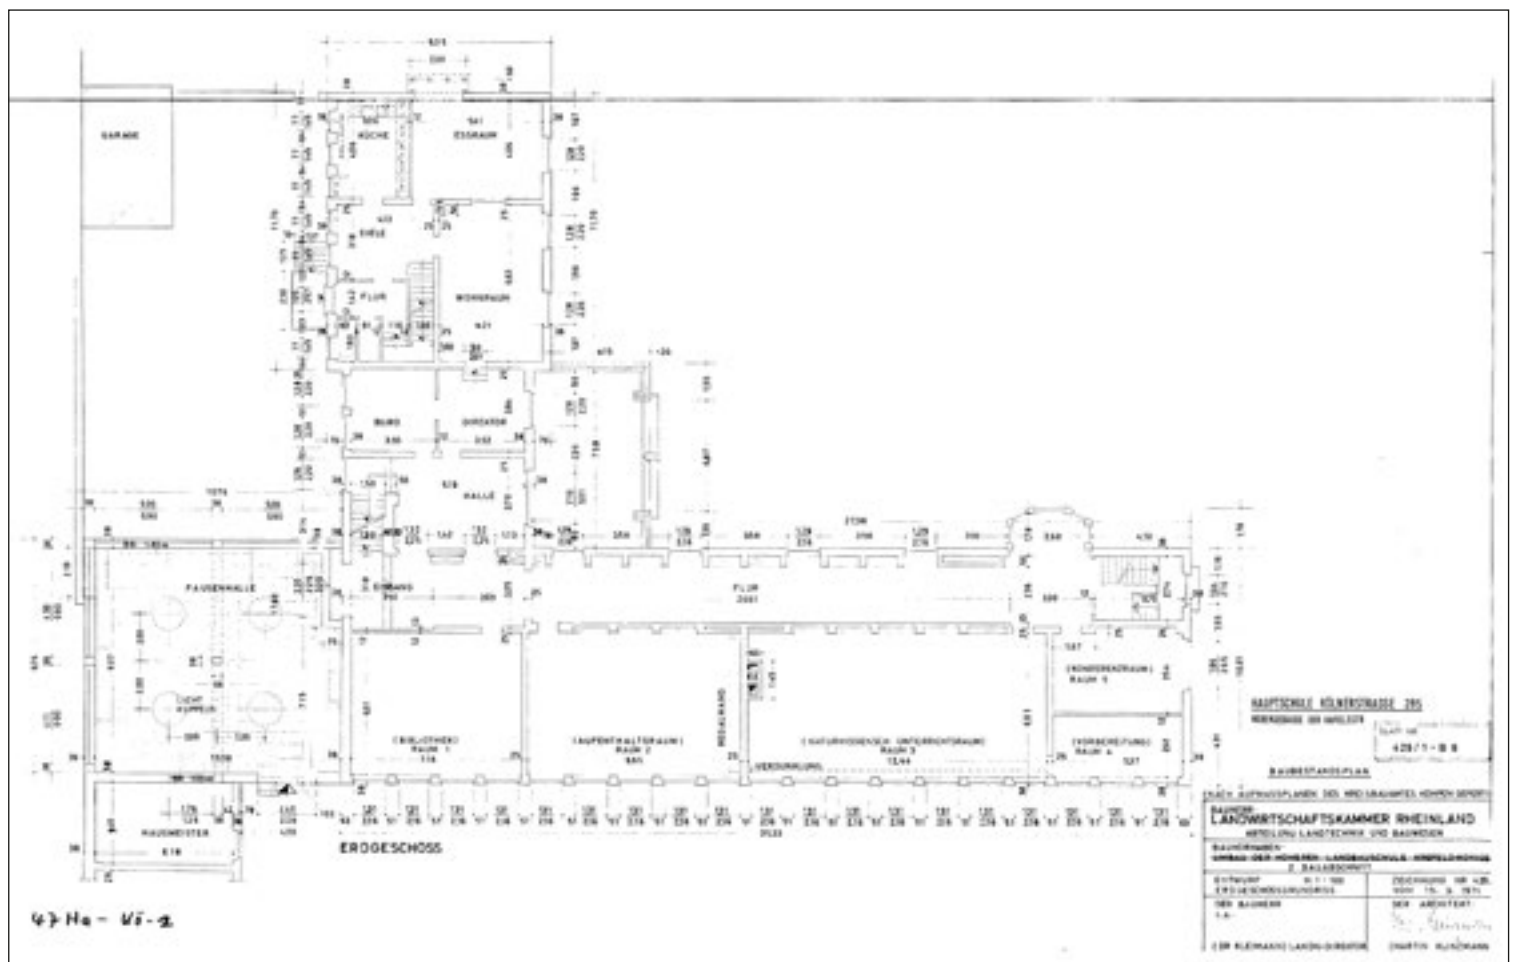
Erdgeschossgrundriss, Bestandsplan von 1971. Bei der Pausenhalle unten links handelt es sich um einen jüngeren Anbau.
